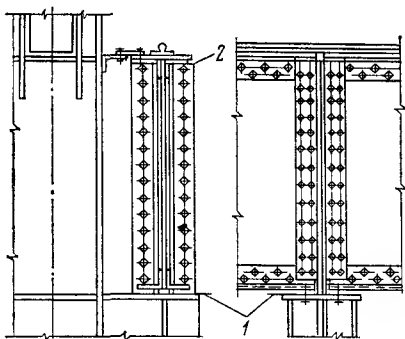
Конструкция опирания тяжелой клепаной подкрановой балки
